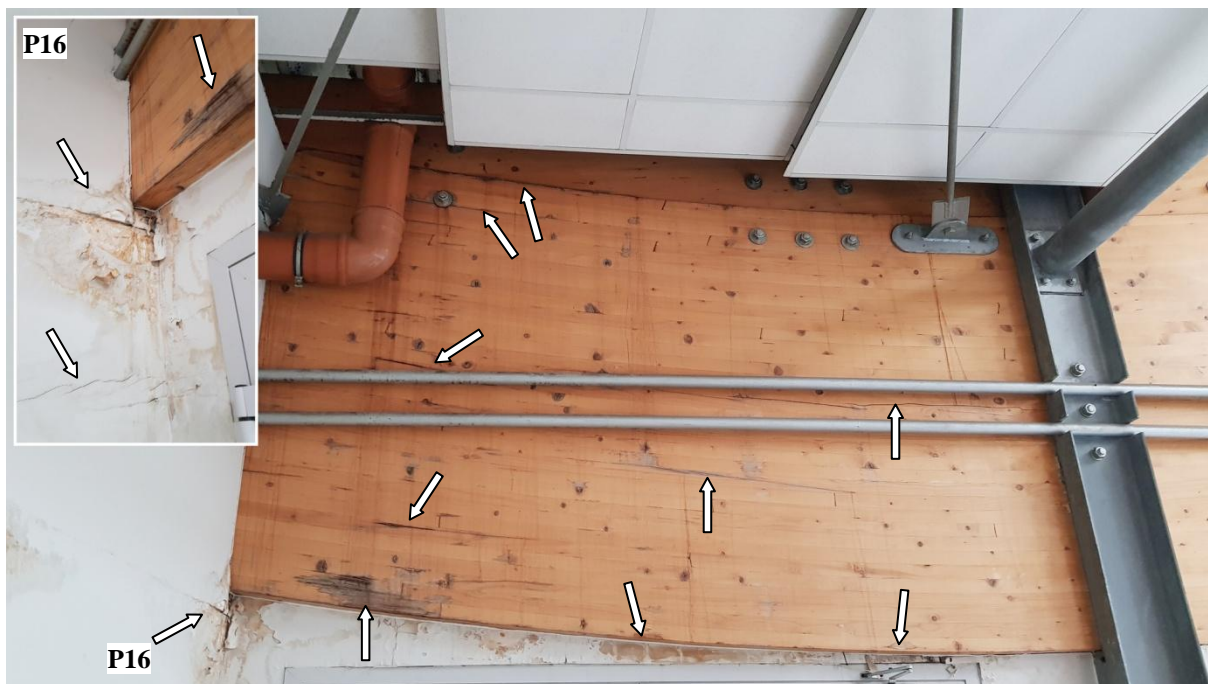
Dźwigar skrajny (pd.-zach., naroże pływalni) – zniszczenia od zacieków z dachu
